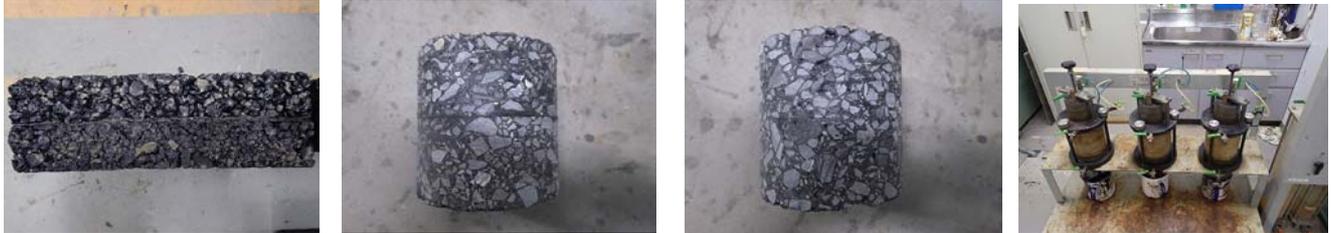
AML 遮水構造体 写真-3 遮水シート有供試体 写真-4 遮水シート無供試体 写真-5 透水試験状況
